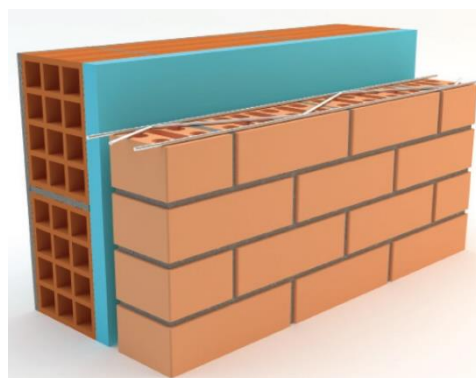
Aplicação de armadura em alvenaria de tijolo com face à vista [43]
